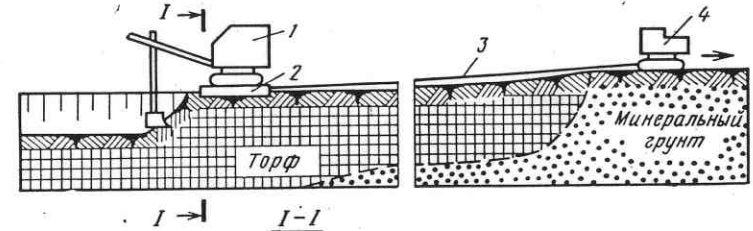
Схема разработки траншеи экскаватором на салазках
